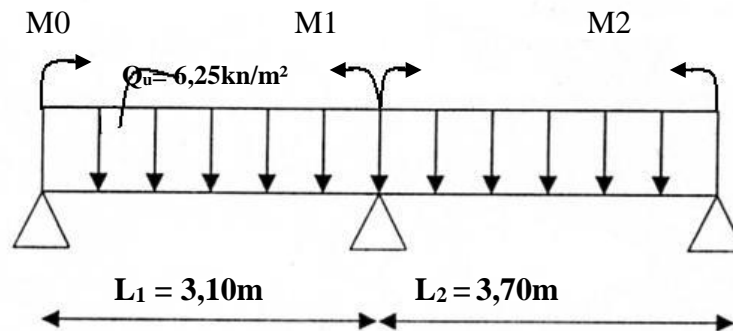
4: schéma statique de la poutrelle type 1 à l'ELU
